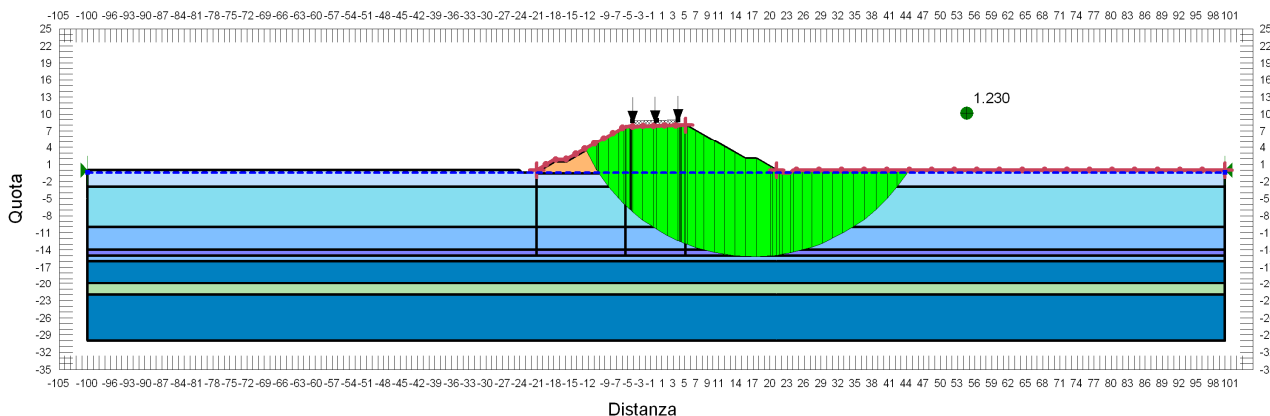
VERIFICA DI STABILITÀ GLOBALE RILEVATO DI H=8.00 M - CONDIZIONE STATICA NON DRENATA.
